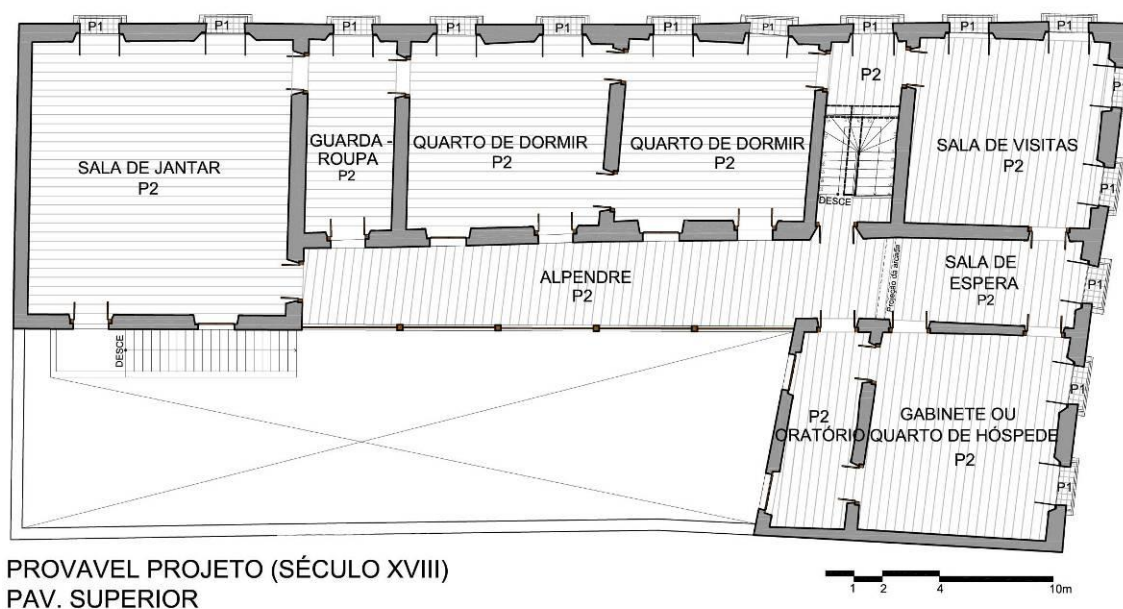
Planta baixa do pavimento superior da Casa Rosada. Provável projeto (século XVIII).
